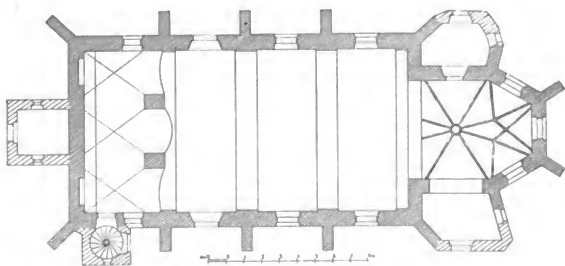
Rokytno. Grundriss der Trinitätskirche.
